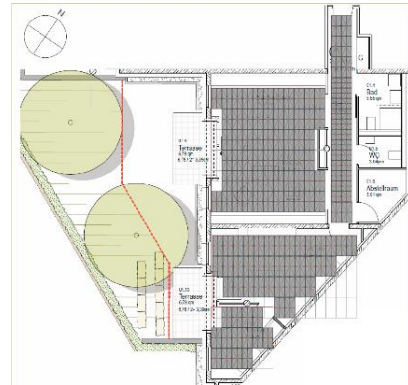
Grundriss mit eingeplantem SensFloor (Beispiel)
